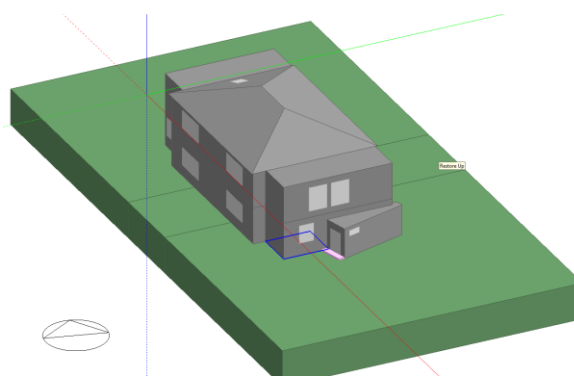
a – Південний фасад будівлі (фактична орієнтація будівлі)
